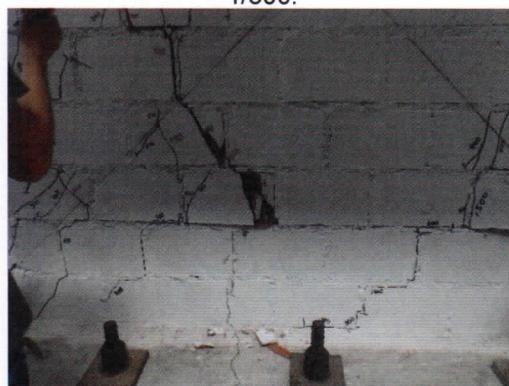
Levantamiento y desprendimiento de parte de un ladrillo en la parte inferior central de la cara Norte para una distorsión de 1/300.
